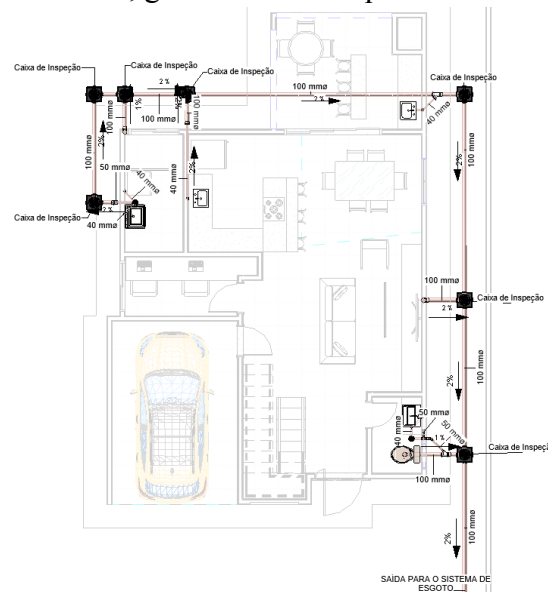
Planta Baixa das Instalações de Esgoto – Pavimento Inferior
